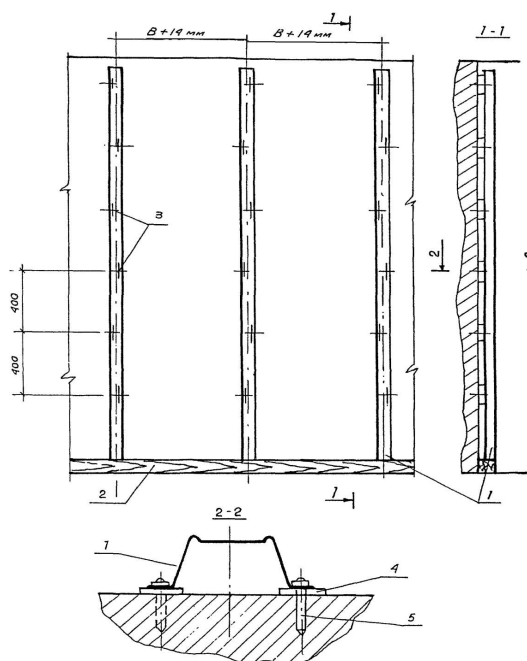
Крепление каркаса из металлического профиля ПП-1 к стене:
